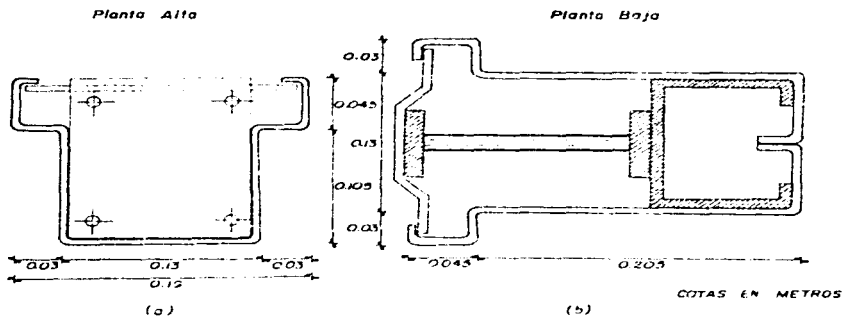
Perfiles Principales de las Columnas Metálicas
